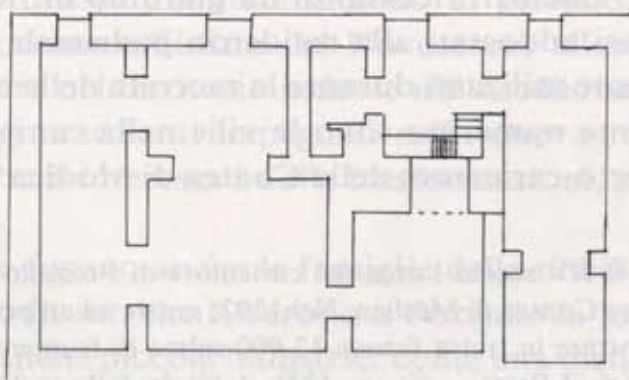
Villa Sant'Alfano. Planimetria del piano rialzato e del seminterrato.
